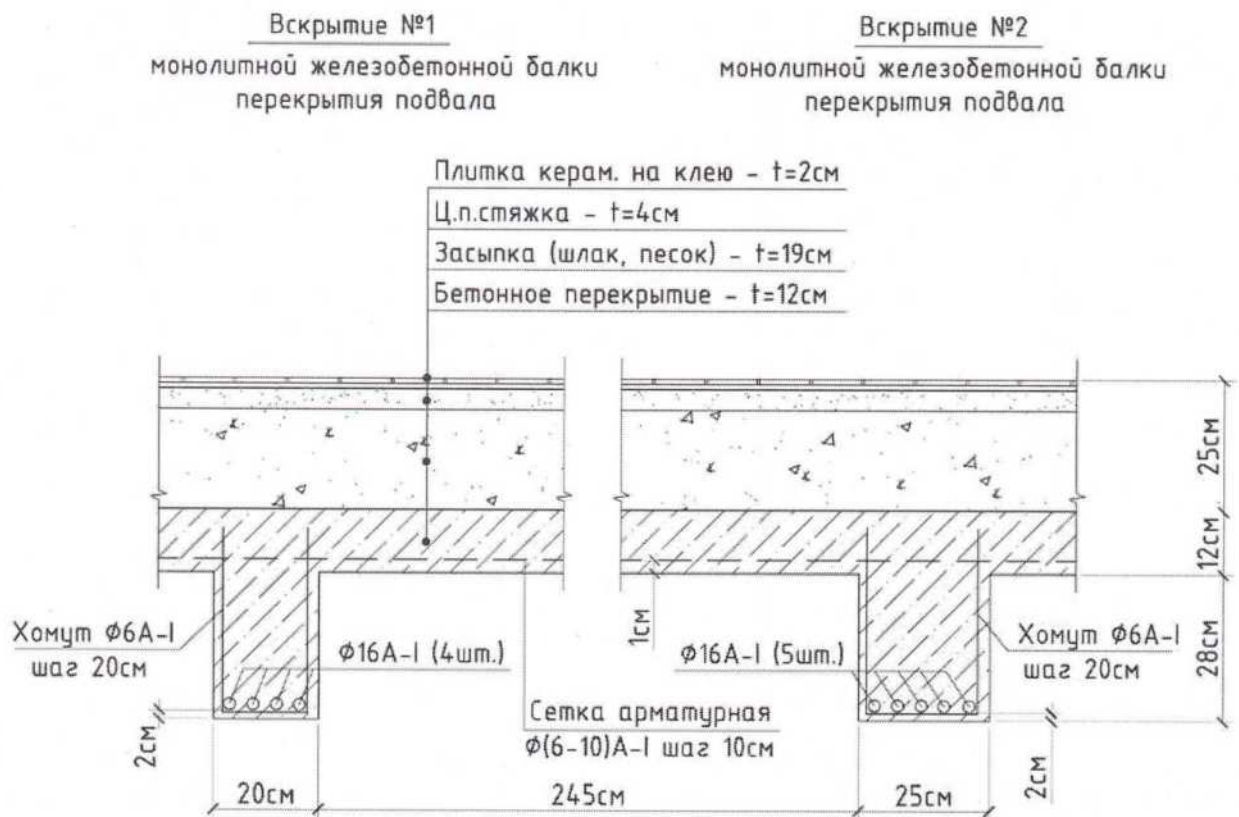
Конструктивное решение перекрытия подвала в местах вскрытий №1 и №2 железобетонных балок и зондажа перекрытия подвала
